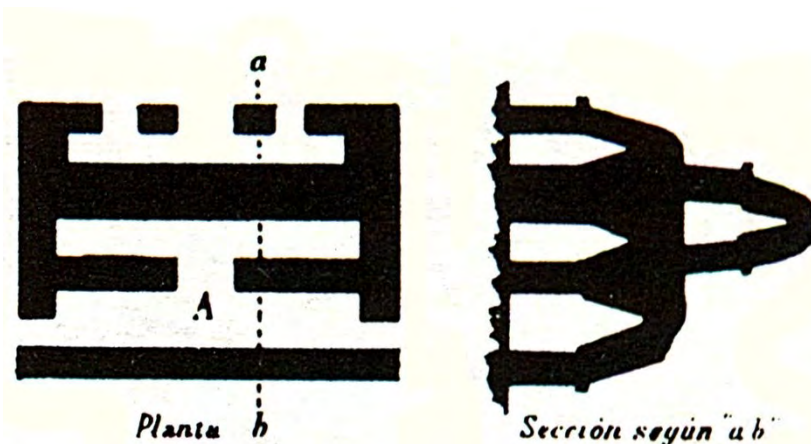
Planta y corte arquitectónico, realizado por Gerónimo López de Llergo, 1925.
